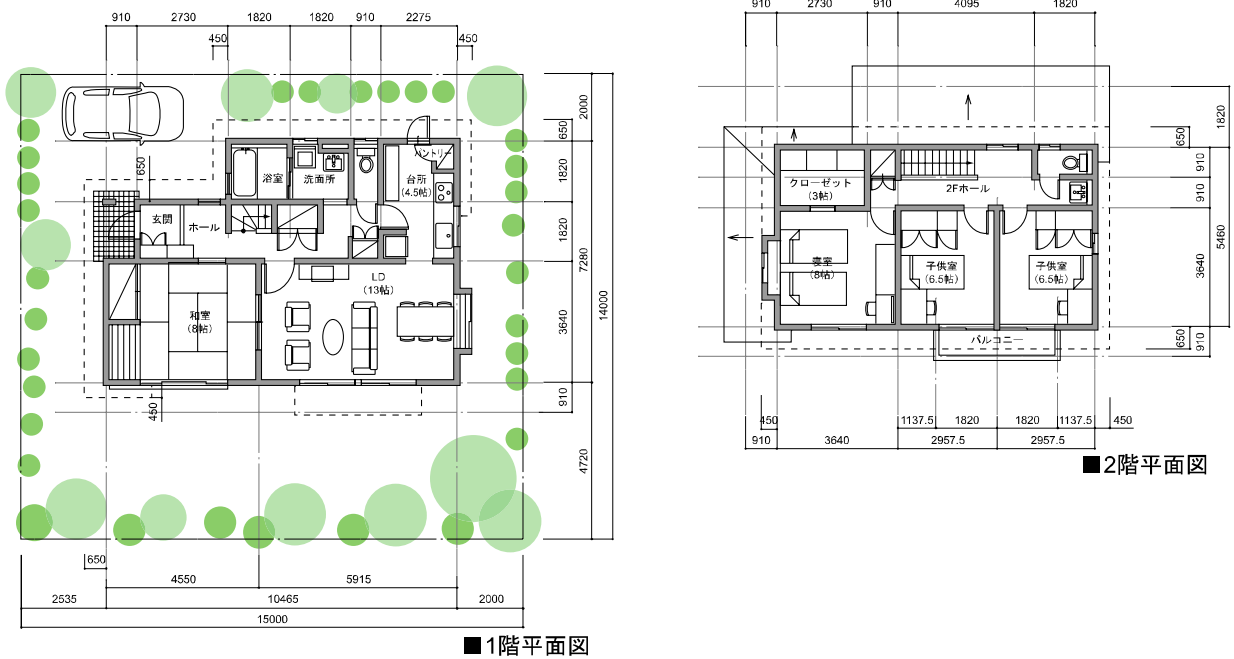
寒冷地用モデルプラン平面図（ a、 b、 地域）
